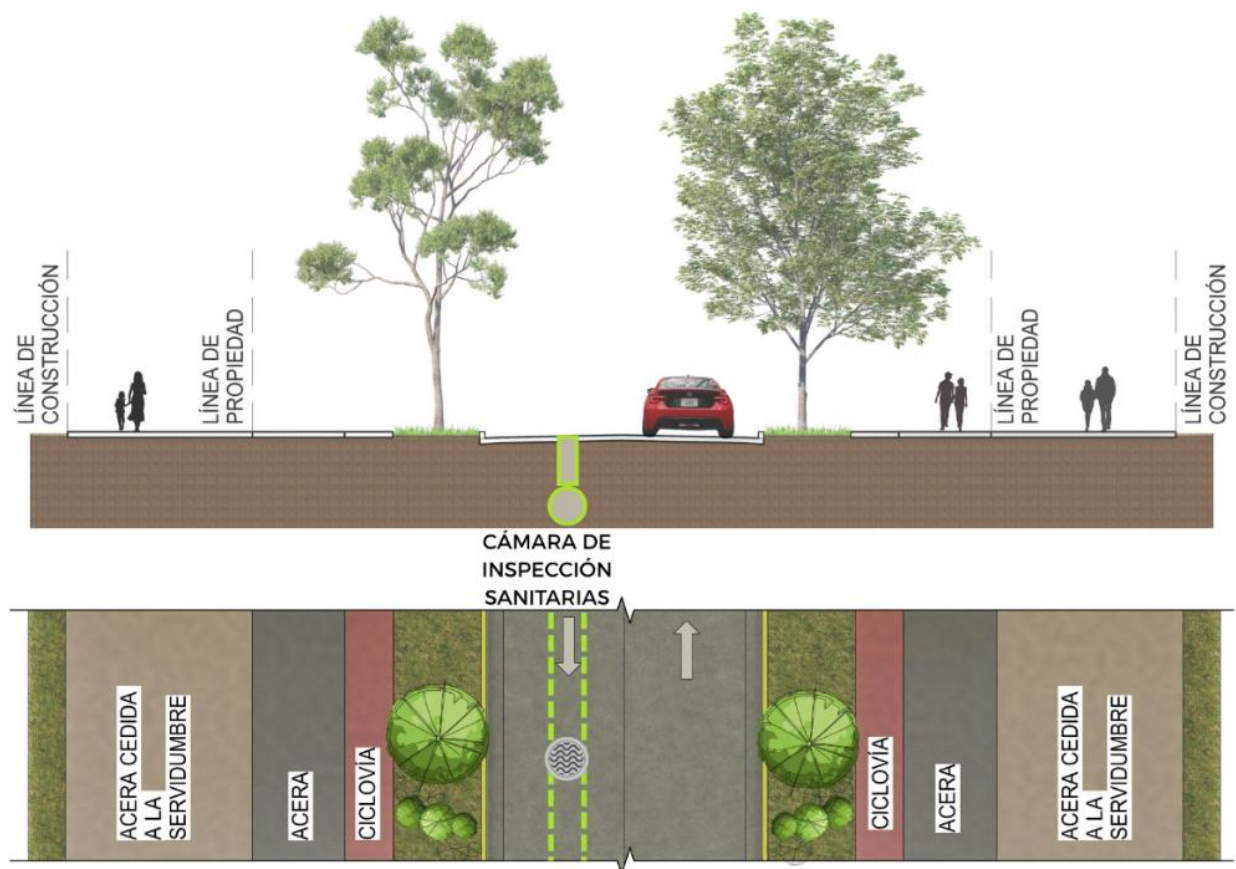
Detalle de ubicación para el alcantarillado sanitario
